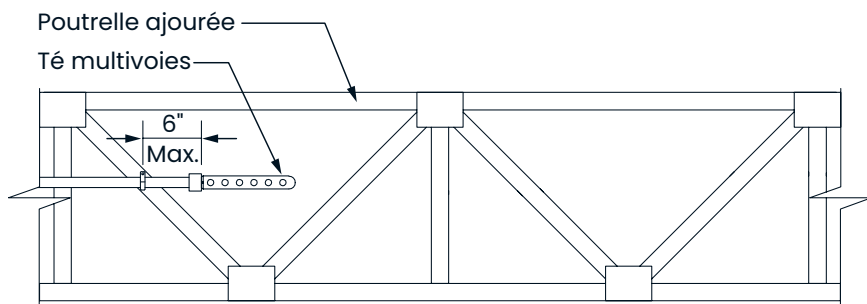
Support de tés multivoies sur des poutrelles de bois ajourées
